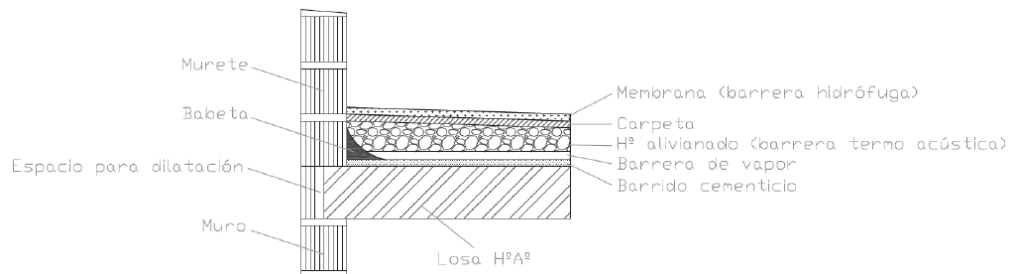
Corte de cubierta plana no transitable. (Apuntes ingeniería civil, 2015)
